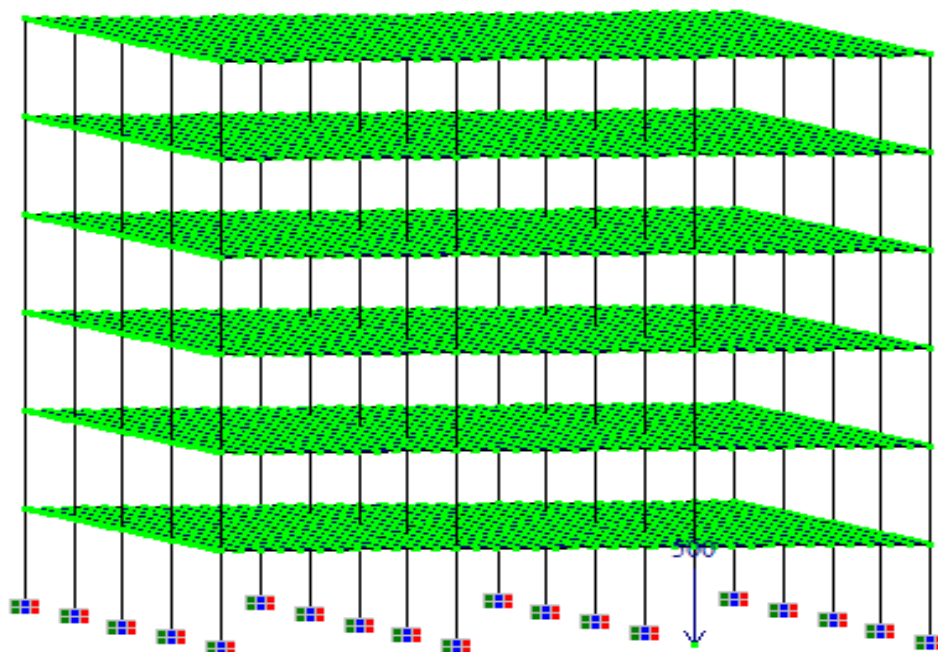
Schéma illustratif du modèle d'étude du bâtiment avec planchers sans hourdis à 6 niveaux avec un chargement vertical sur le poteau de rive
